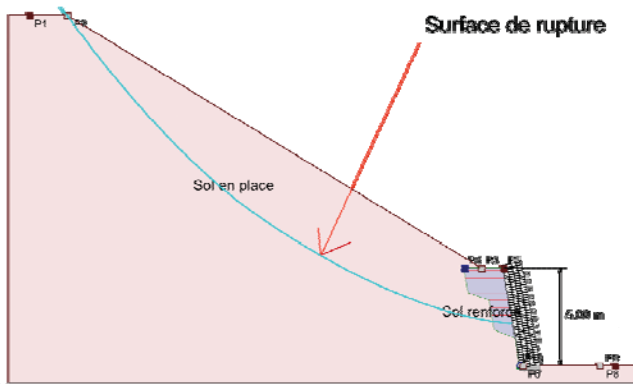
COUPE DE CALCULS, STABILITE MIXTE
